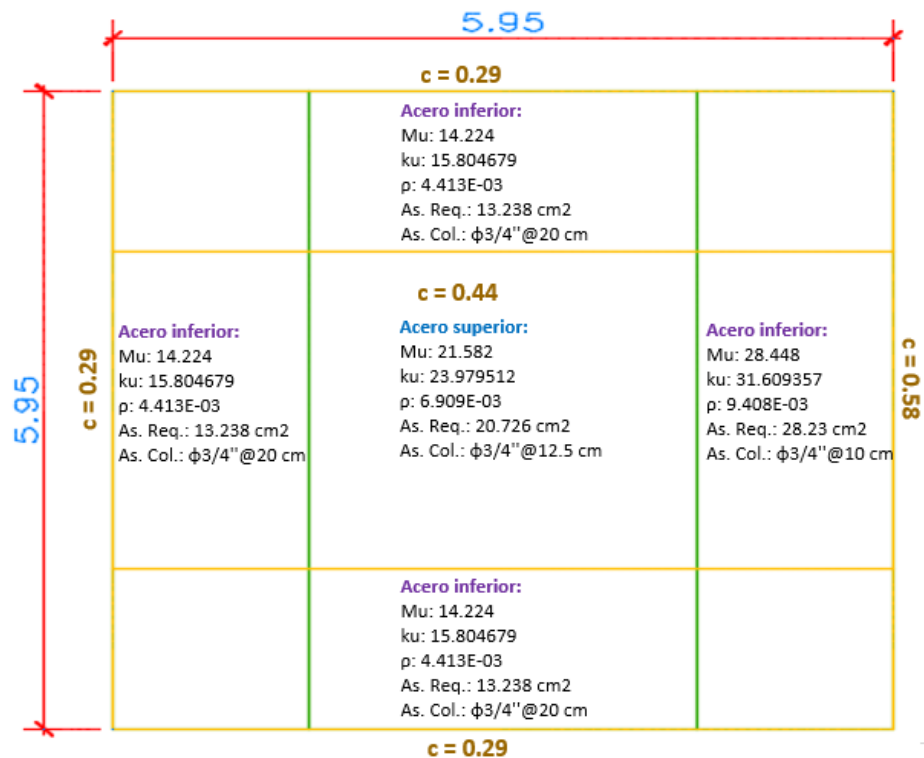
As de la losa - Losa de cimentación con viga - Sistema dual tipo I
